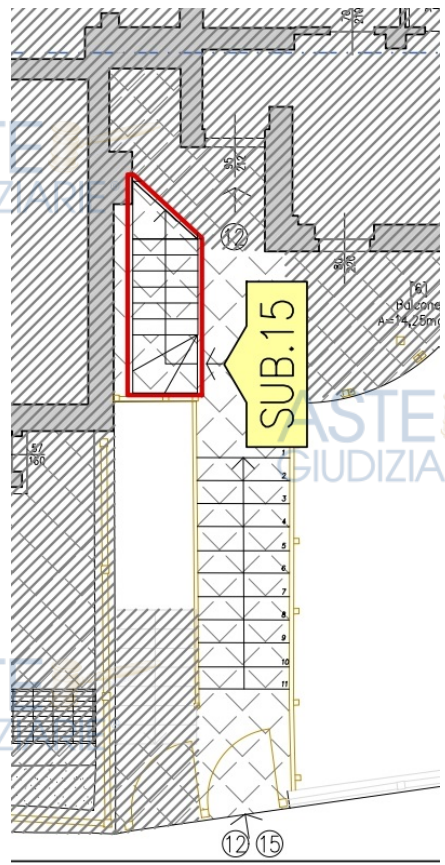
Estratto Tav.A04 S.C.I.A Prot. 15716 del 18.11.2025 – Piano terra
